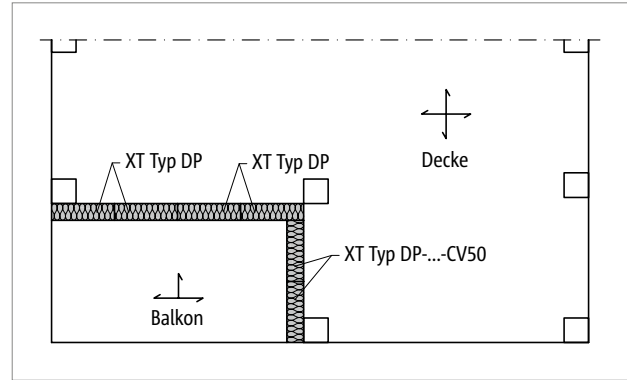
Schöck Isokorb® XT Typ DP: Einsatz in Flachdecken
